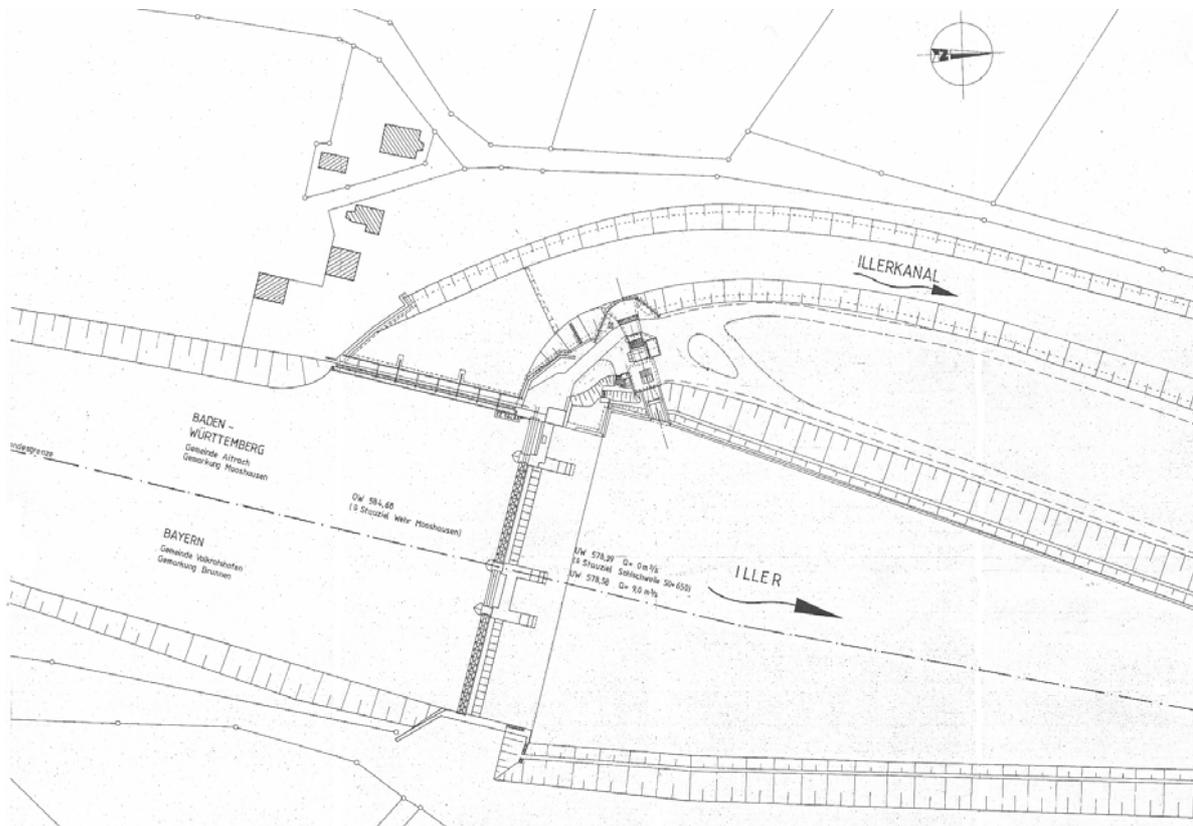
Lageplan des Wehres Mooshausen mit der Ausleitung in den Illerkanal und dem Kleinkraftwerk Mooshausen
